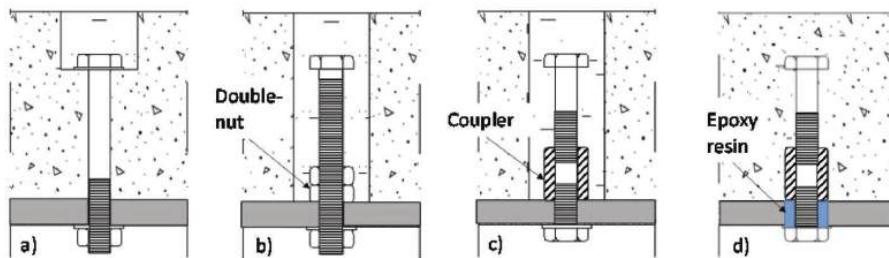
Types de connecteurs boulonnés démontables a) boulon précontraint, b) double écrou, c) connecteur à système de couplage, d) connecteur de cisaillement boulonné avec résine époxy [44]
